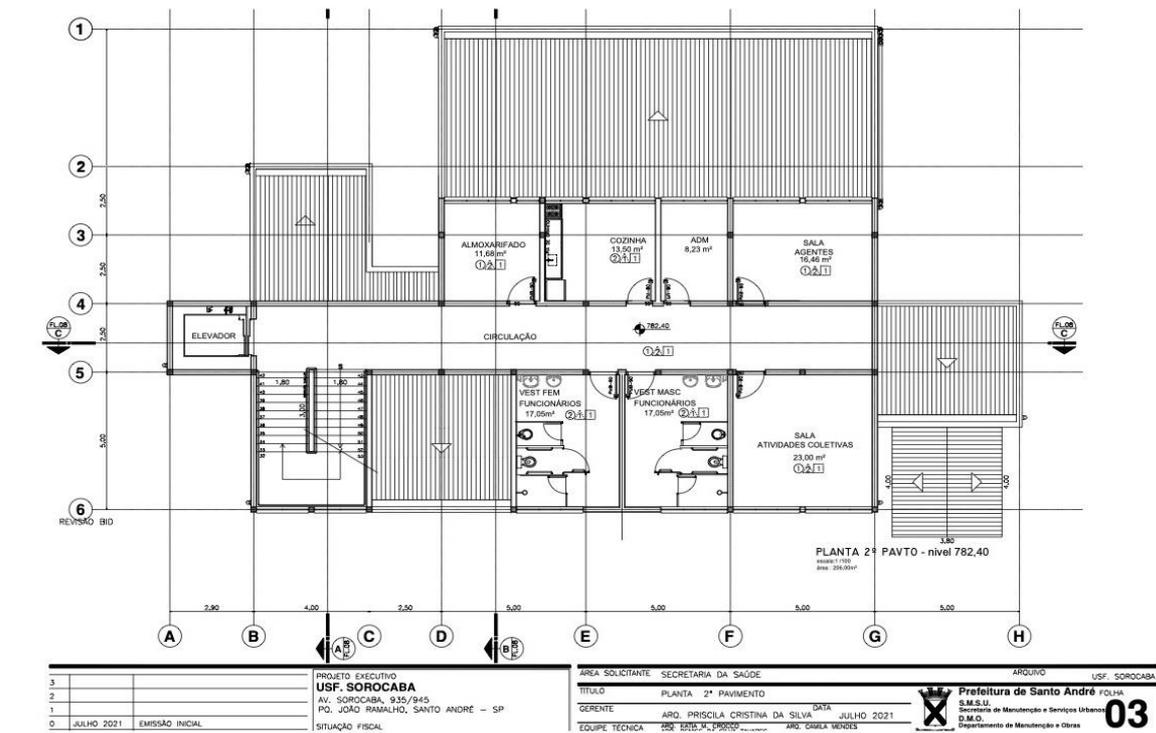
USF Sorocaba. Planta do segundo pavimento.
